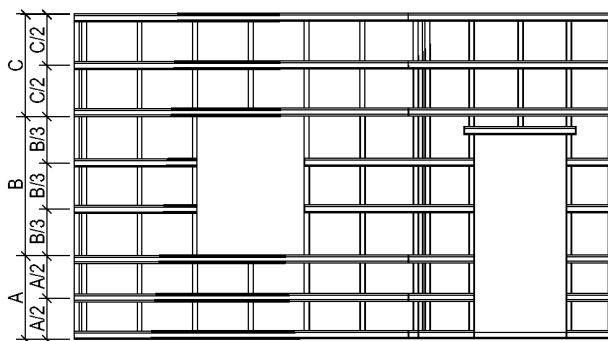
Монтажная схема горизонтальной обрешетки для стен типа 1
